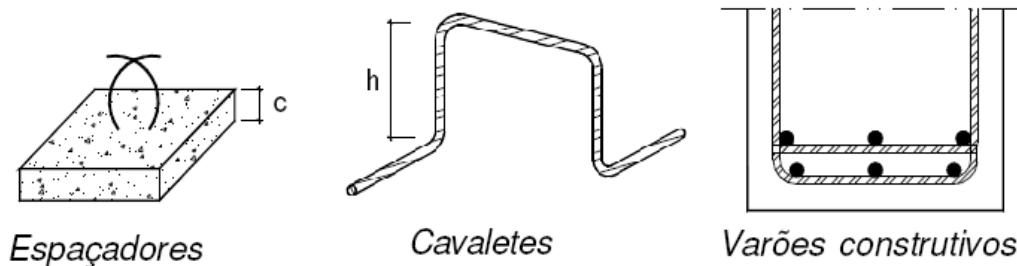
Elementos necessários para assegurar o posicionamento das armaduras em obra [16].
